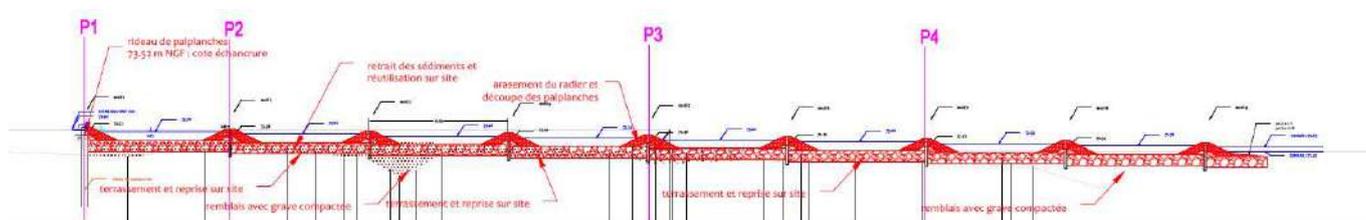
Le premier rideau de palplanche servira de batardeau pendant toute la durée des travaux - LOING MEDIAN
